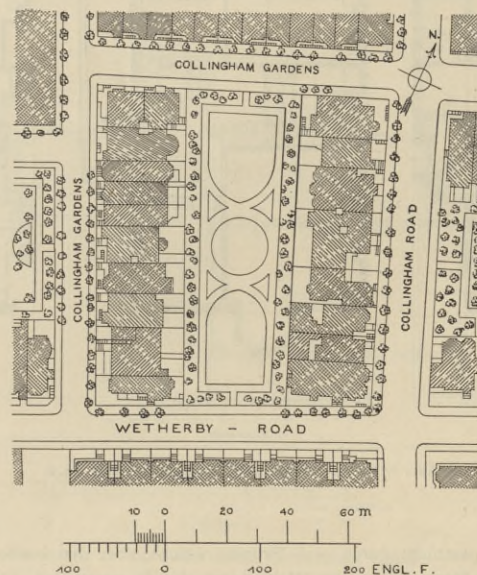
Wohnhäuser in Collingham Gardens, London, Lageplan.
